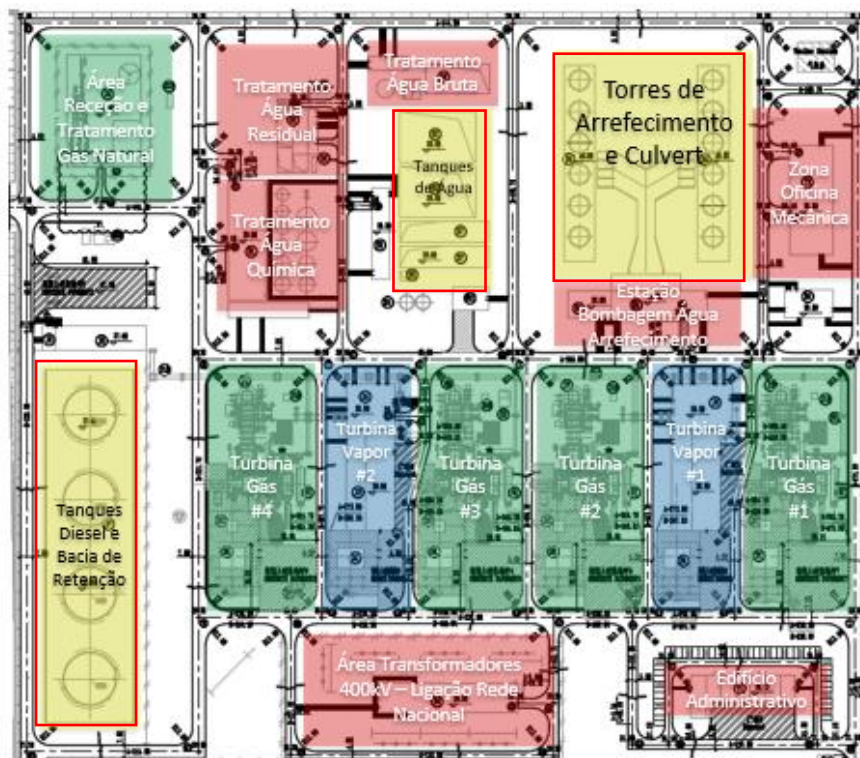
Planta da Central de Ciclo Combinado do Soyo.
